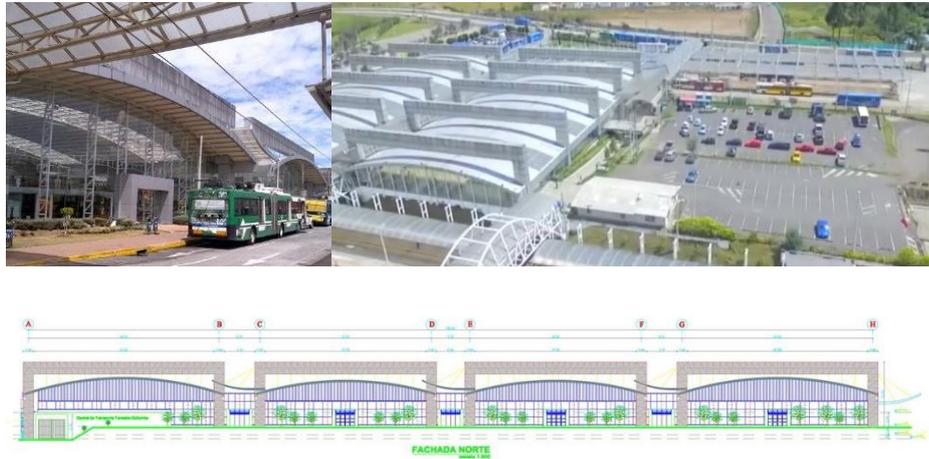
Terminal Terrestre de Quitumbe, Ecuador – Fachada Principal
